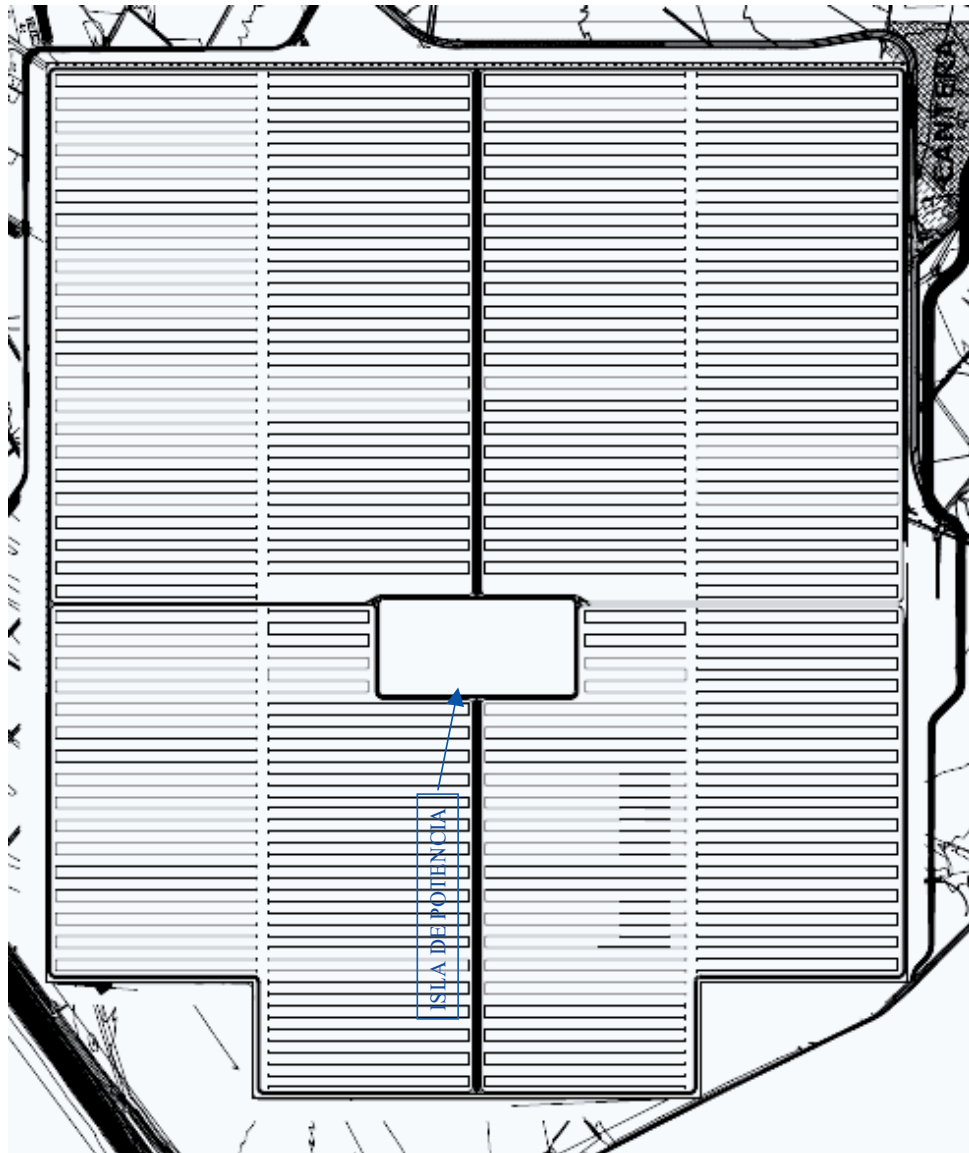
Plano en planta de la termosolar. Campo solar e isla de potencia.
